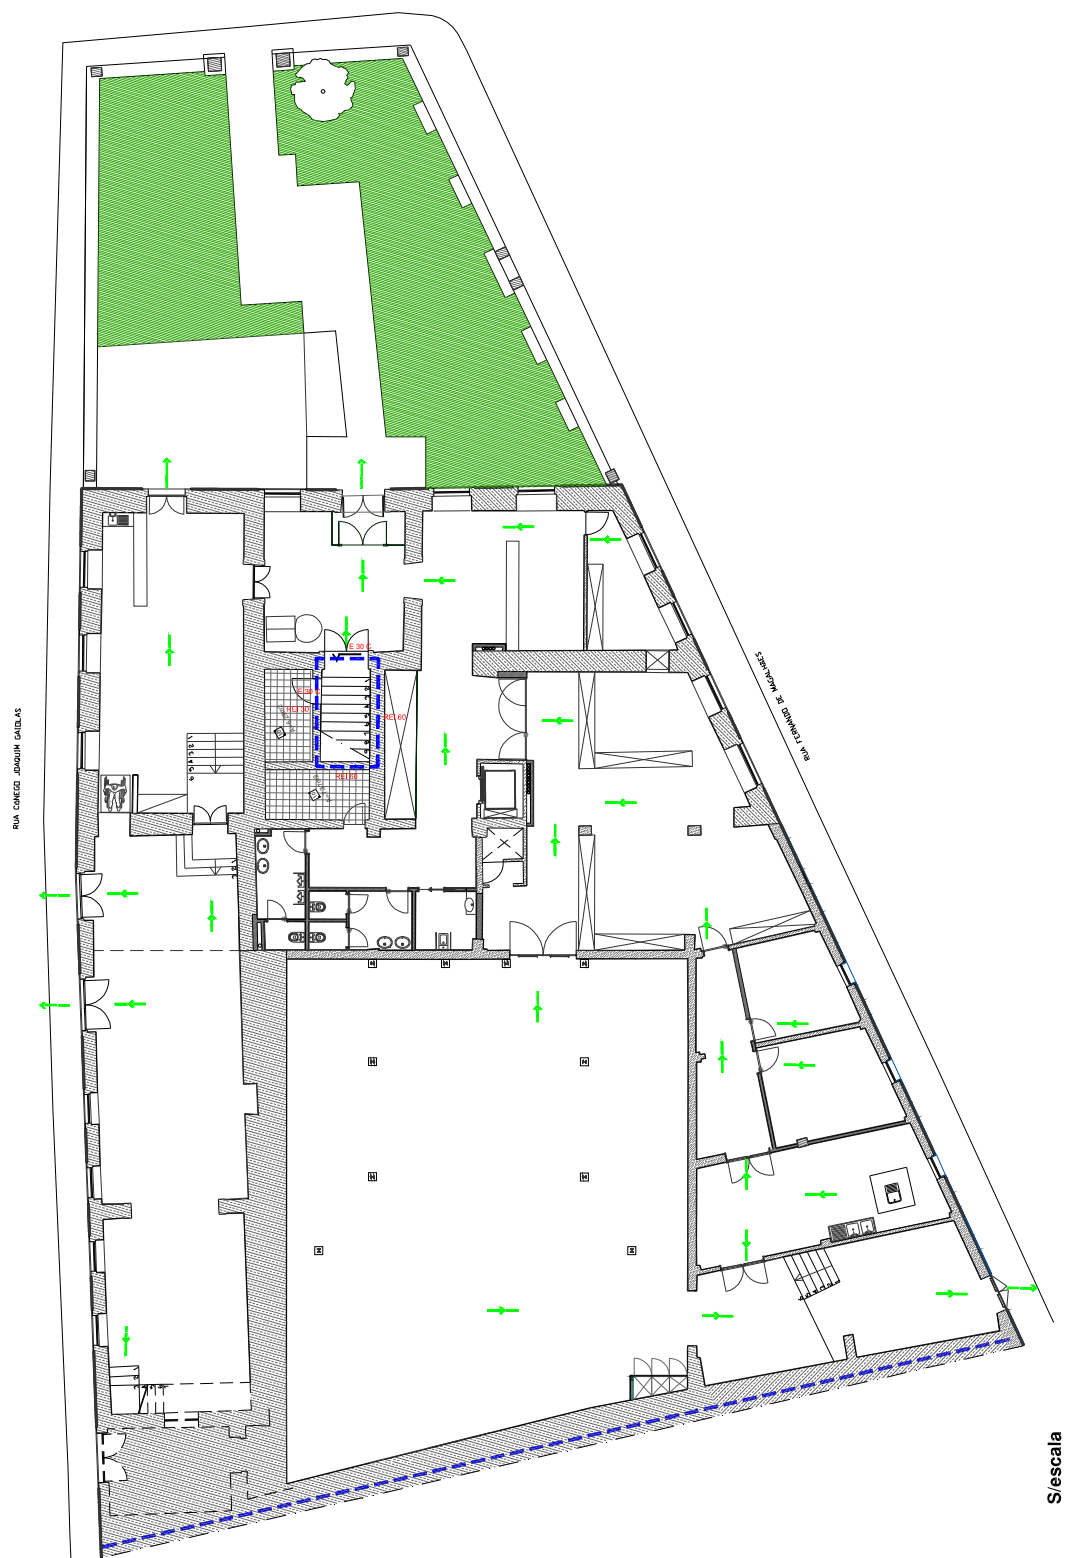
Planta do 1º Piso - Proposta de inclusão de via vertical de evacuação.
